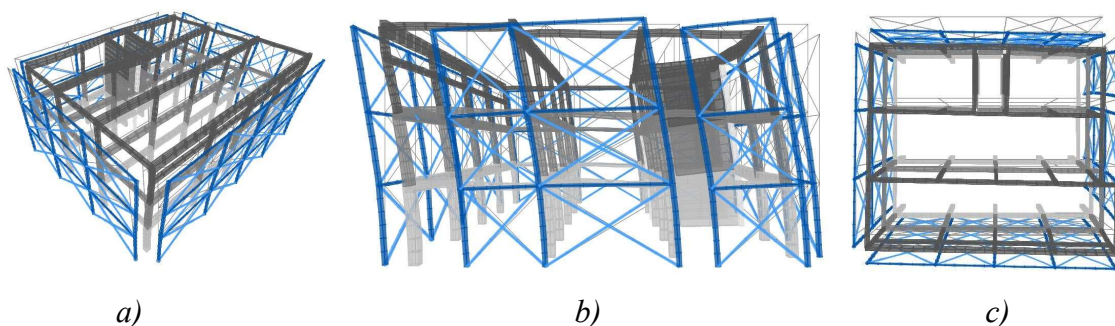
Deformate modali del secondo modo di vibrare: a) vista prospettica 3D, b) vista prospettica frontale, c) vista prospettica dall'alto
